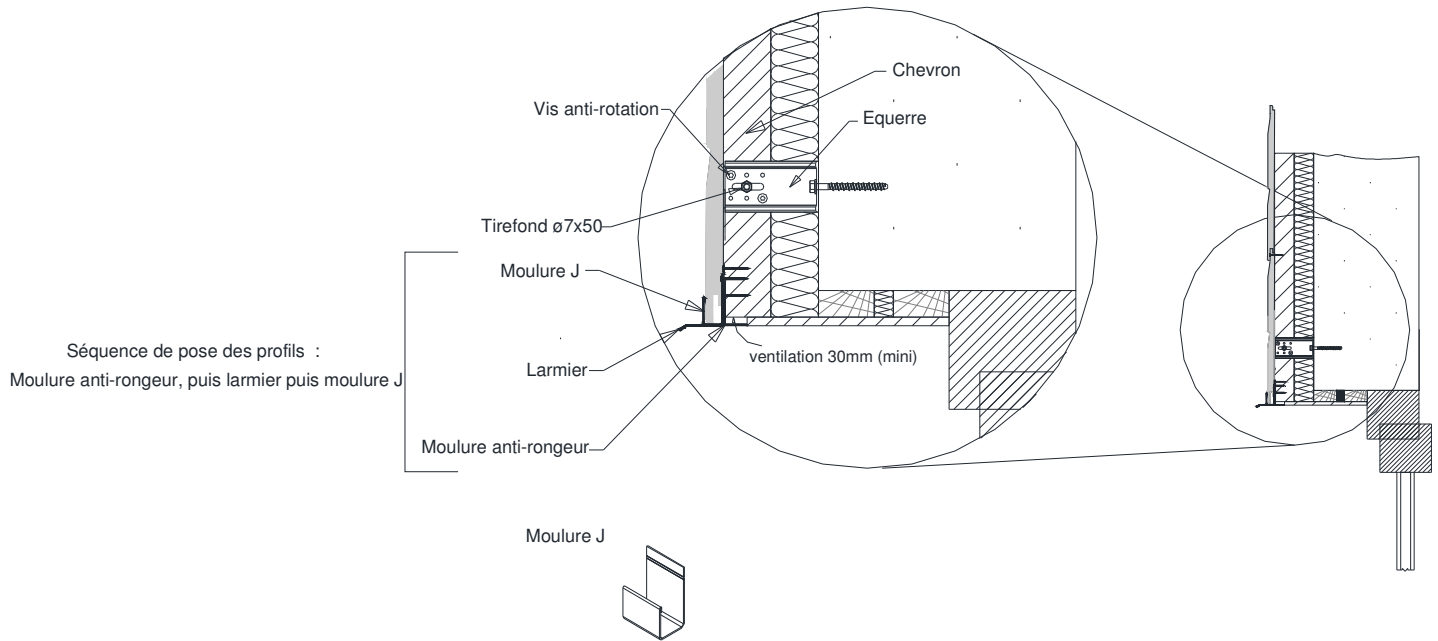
is – Linteau – Pose en bardage (coupe verticale)
